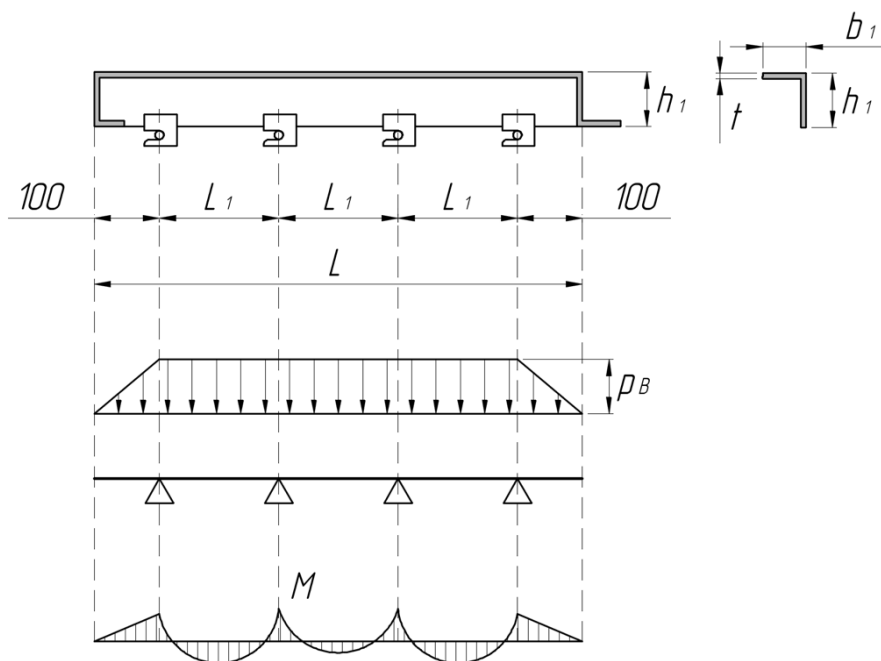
Расчётная схема вертикального ребра панели (многопролетная неразрезная балка).
